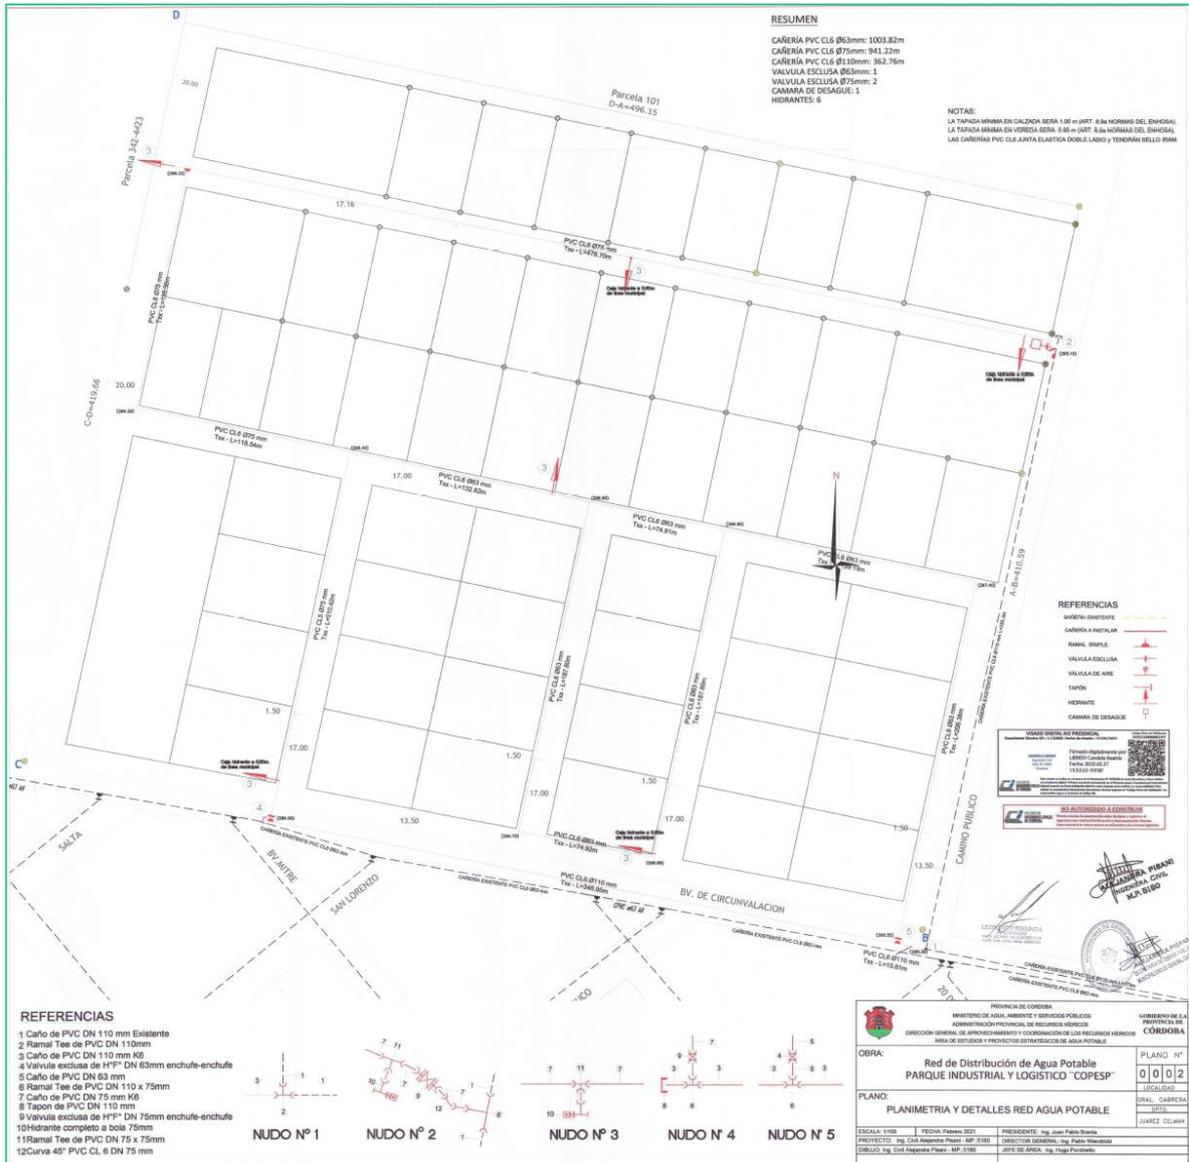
Planimetría y detalles de Red de Agua Potable
